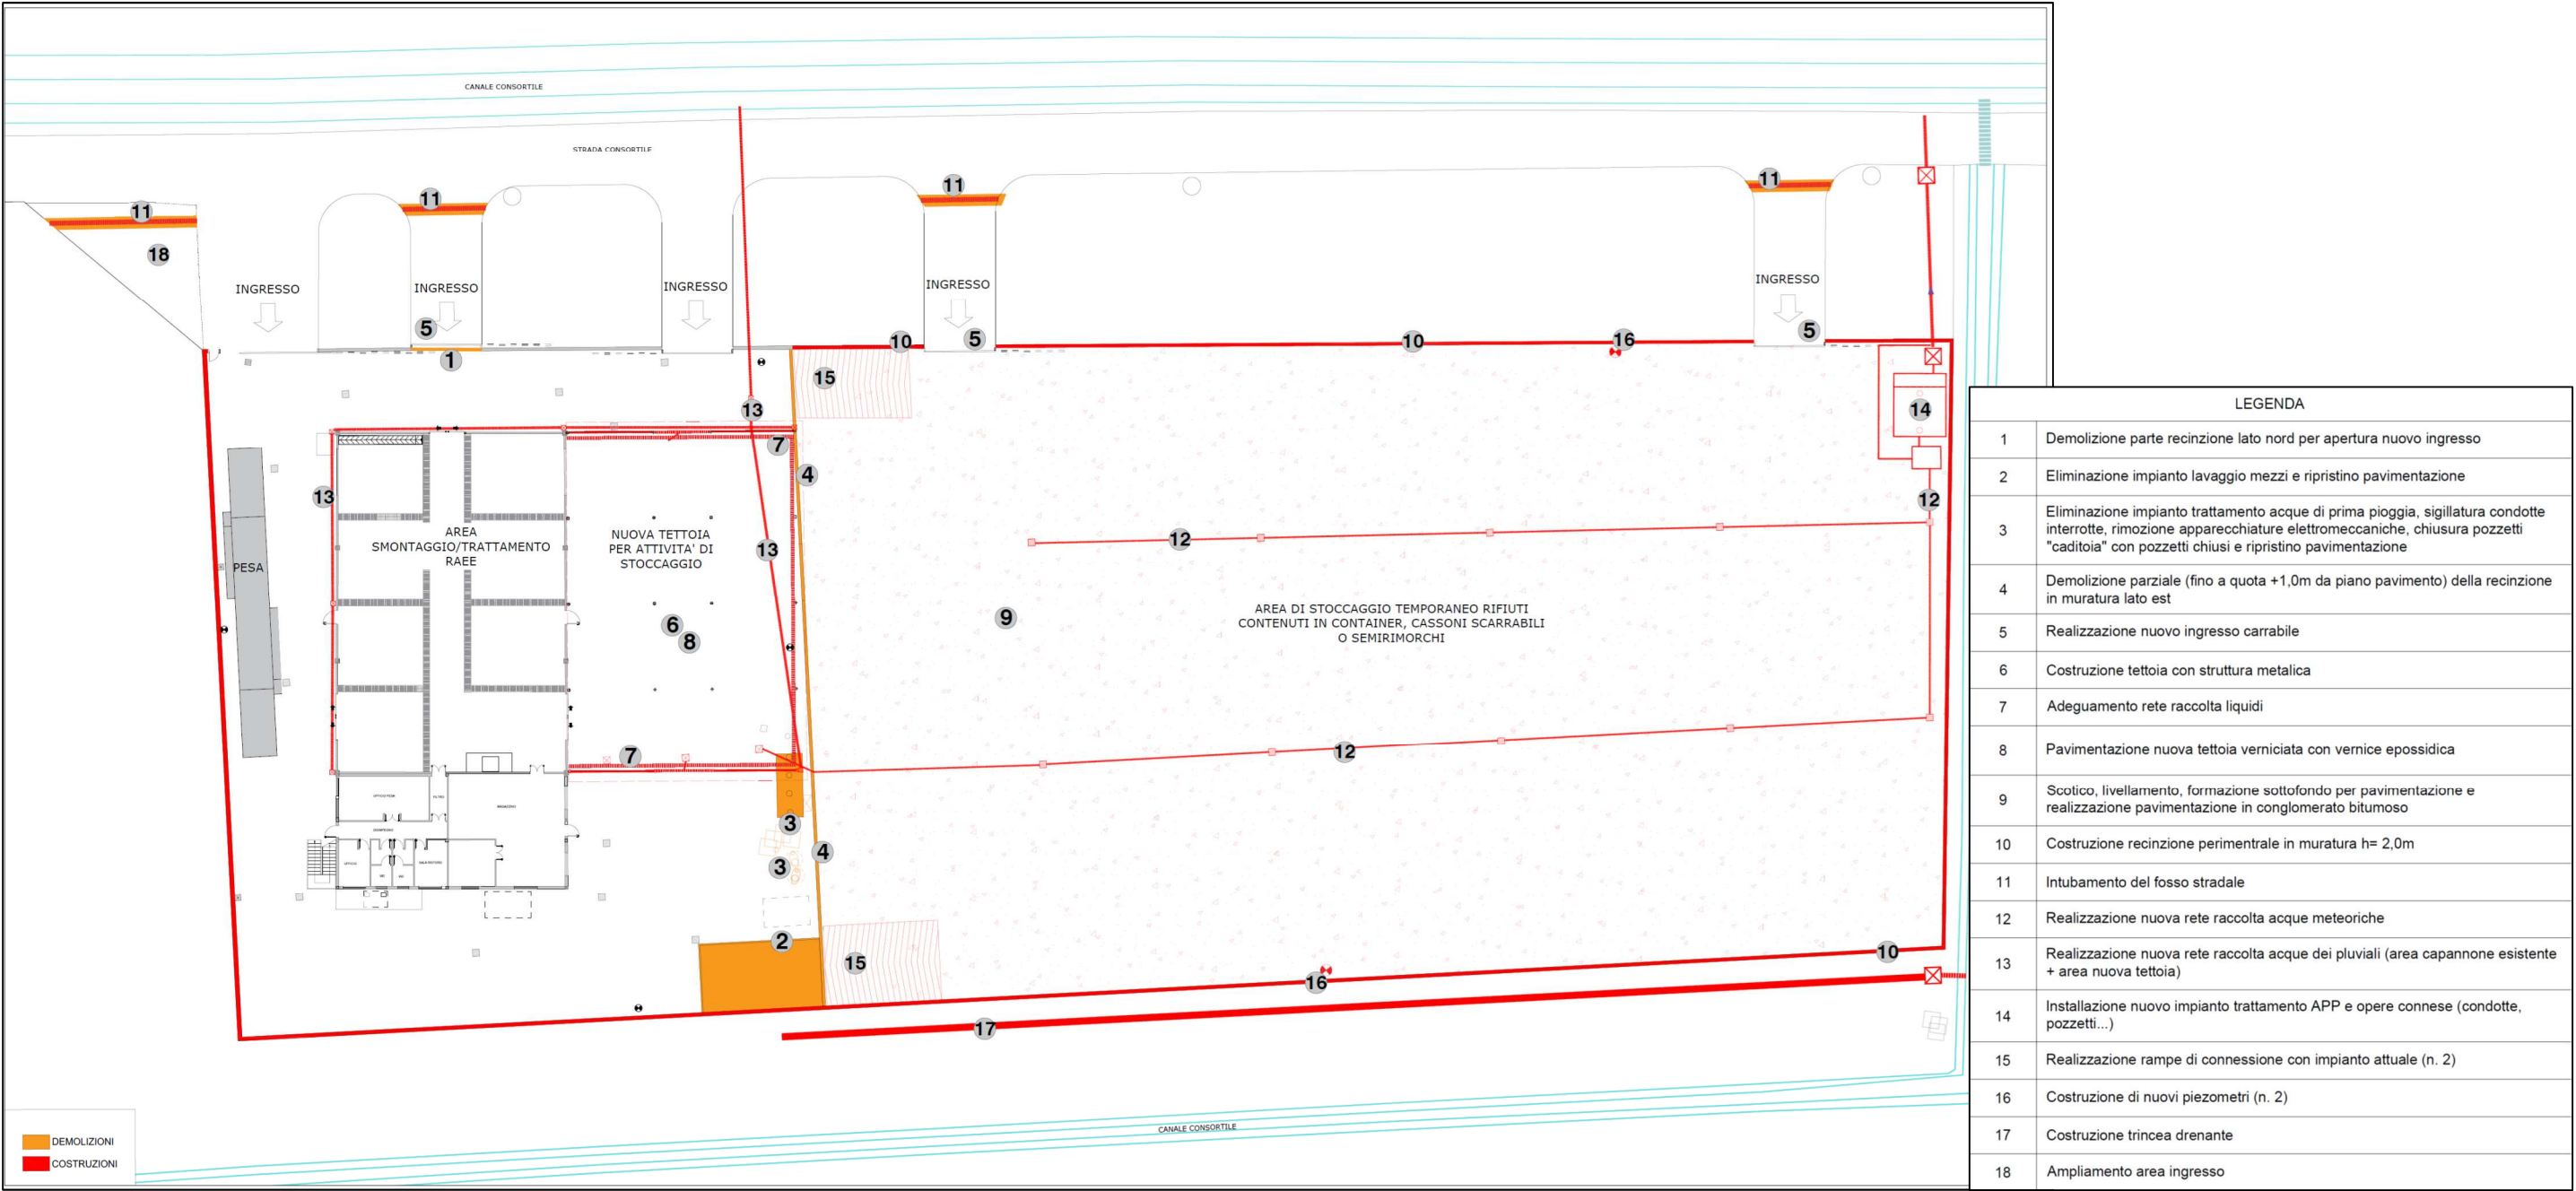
/I: Planimetria delle opere in demolizioni e costruzione
